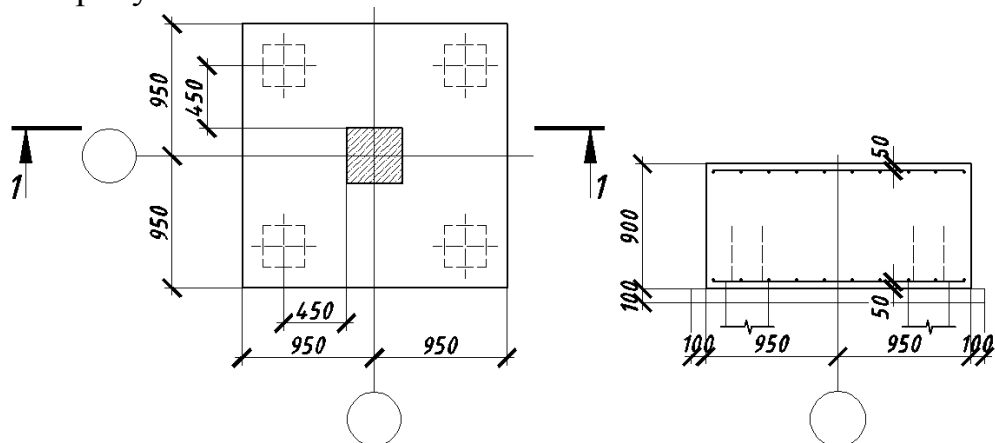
Расчетная схема при определении арматуры подошвы фундамента
